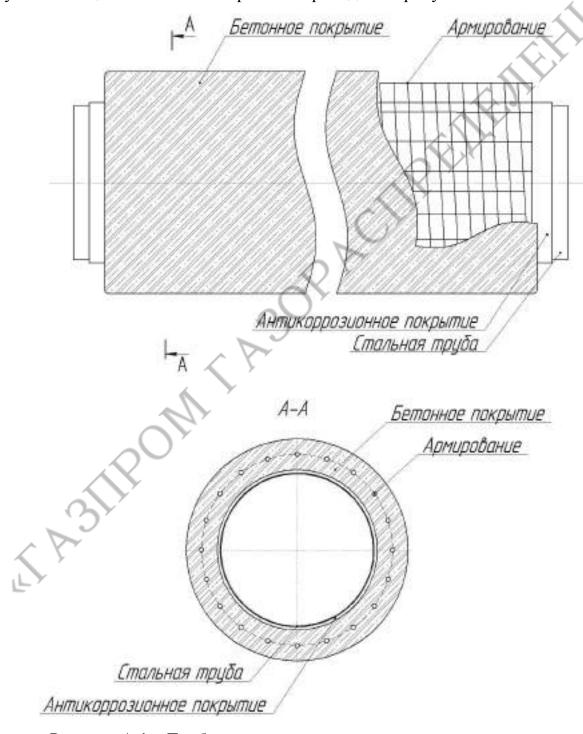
Труба с антикоррозионным покрытием и наружным утяжеляющим бетонным покрытием
